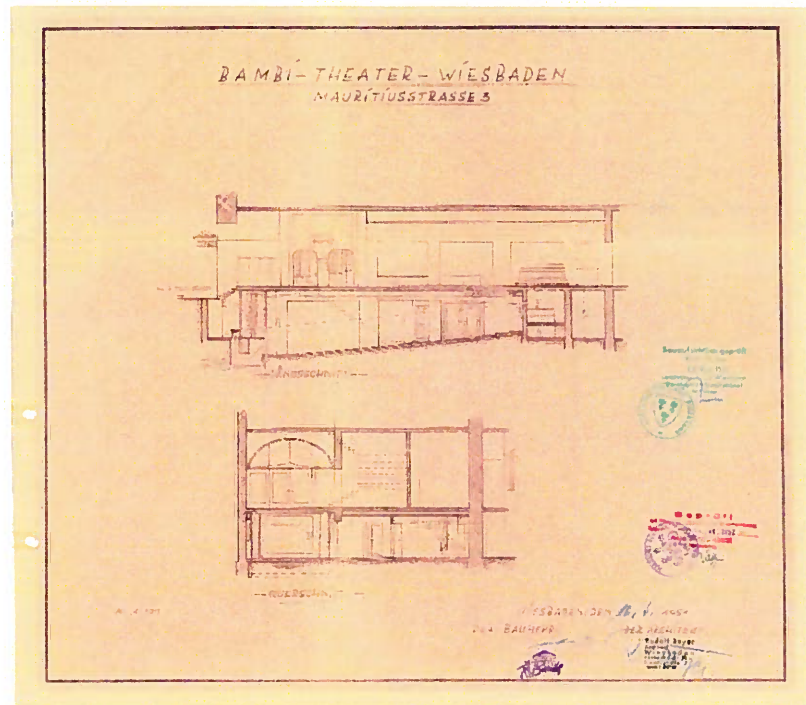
Bauantrag für das „Bambi“ Kino, 1951, Bauakte Stadt Wiesbaden
